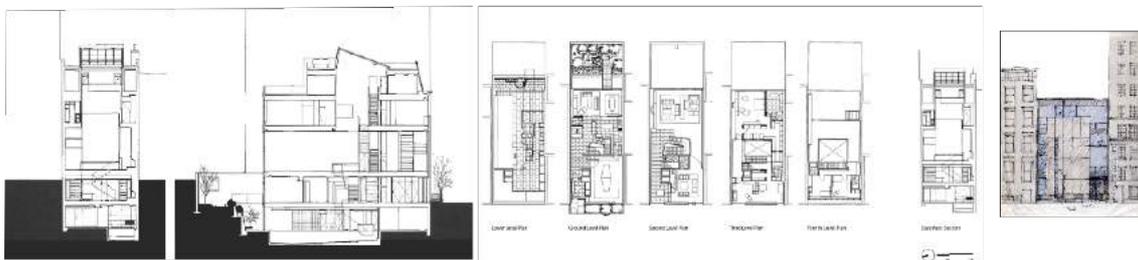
Plantas, elevações e croquis, Town House, 1996. Fonte: <http://twbta.com/work/new-york-city-townhouse>.
